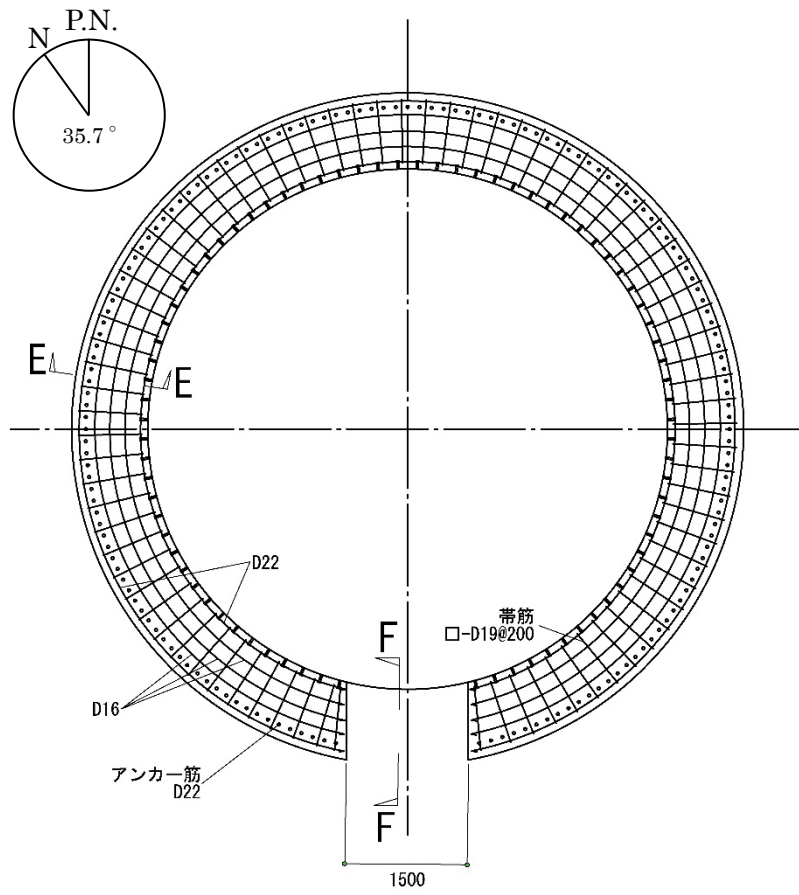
筒身最下部平面図 (T.P. +1.50 m)
